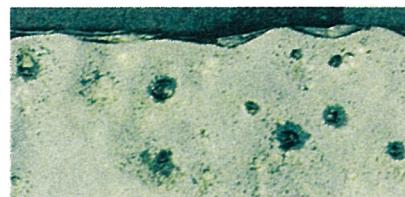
トラス橋の弦材高力ボルト継手部の腐食事例
